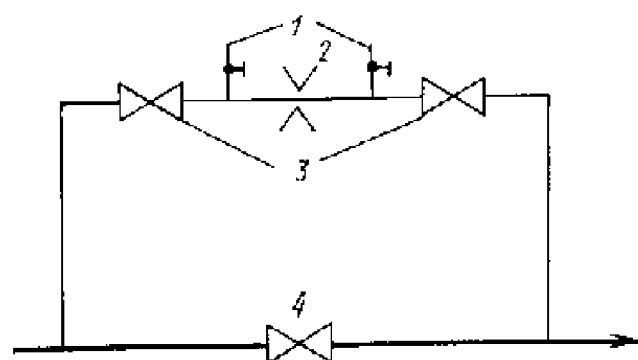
Схема байпаса для установки дроссельной диафрагмы на трубопроводе тепловой сети
